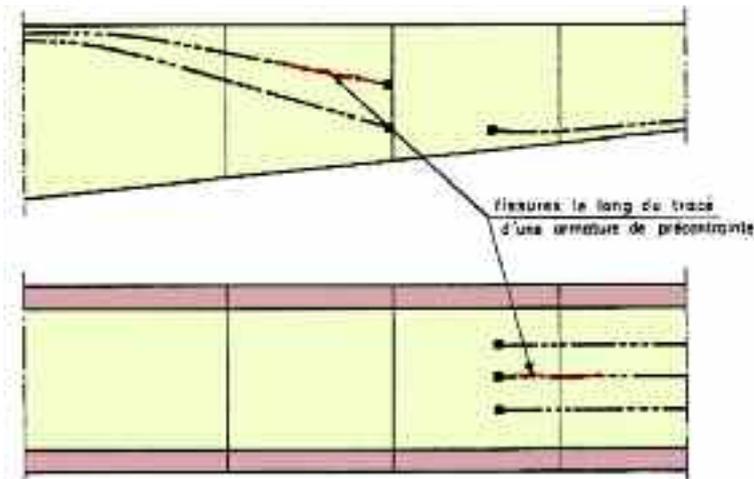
fissures de diffusion suivant le tracé des câbles
